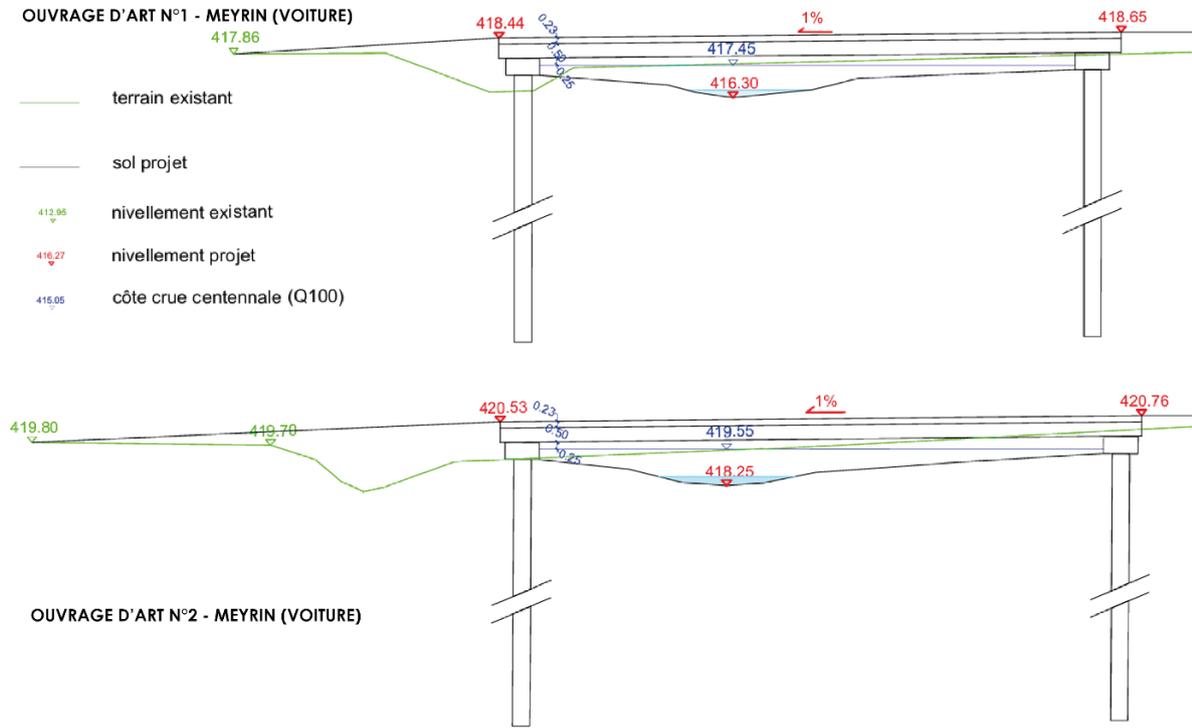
Coupe des ouvrages de franchissement sur la rue de Meyrin, Bordas+Peiro, avril 2024
